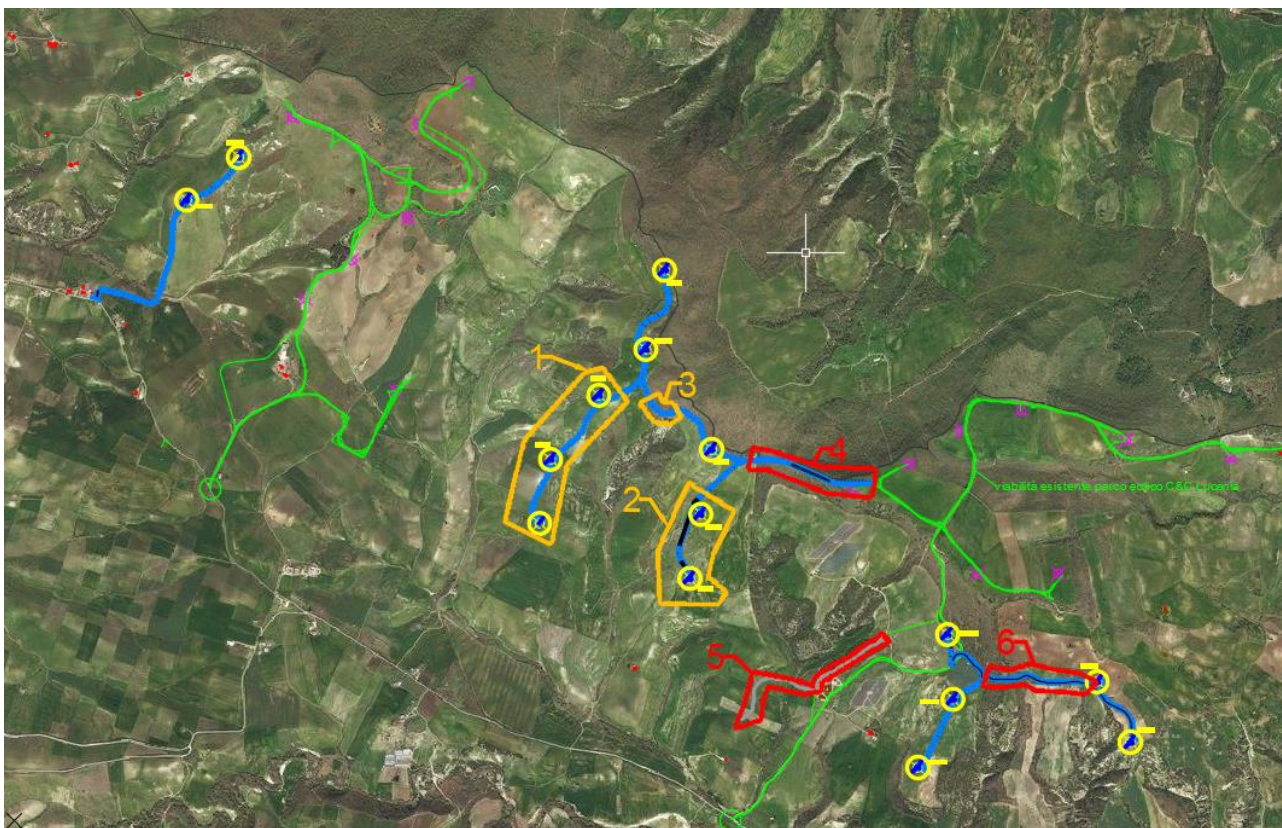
Nuovo Layout – nuove strade di accesso con evidenza tipologia modifiche
